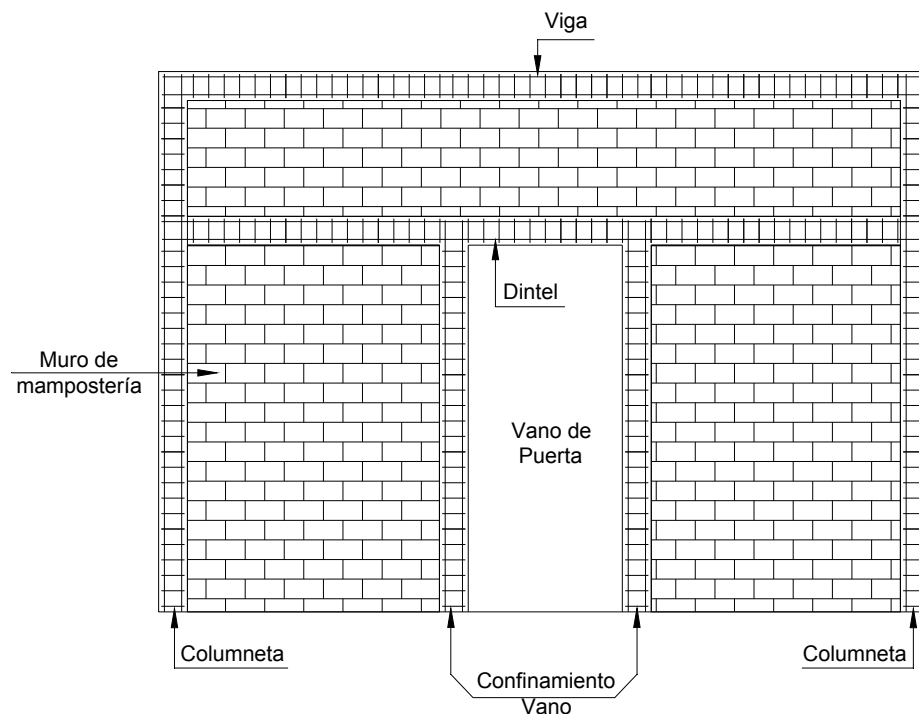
Reforzamiento de un muro de mampostería con elementos de confinamiento en concreto reforzado.
